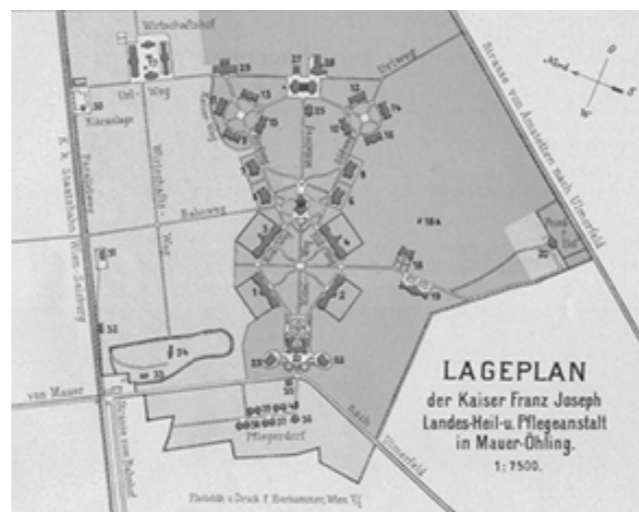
Lageplan der Kaiser Franz Joseph Landes-Heil- u. Pflegeanstalt in Mauer-Öhling
